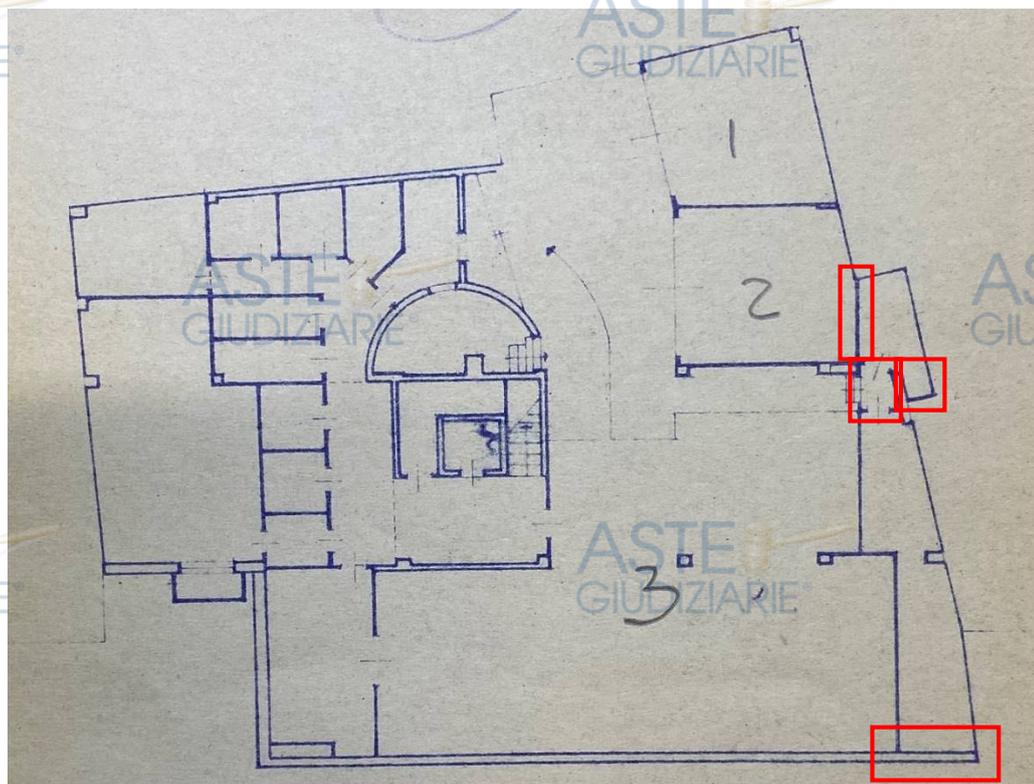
Estratto pianta di progetto di variante Prot. Gen. 13711/1967 Prot. U.T. 2161 del 17.05.1967 -Piano interrato
